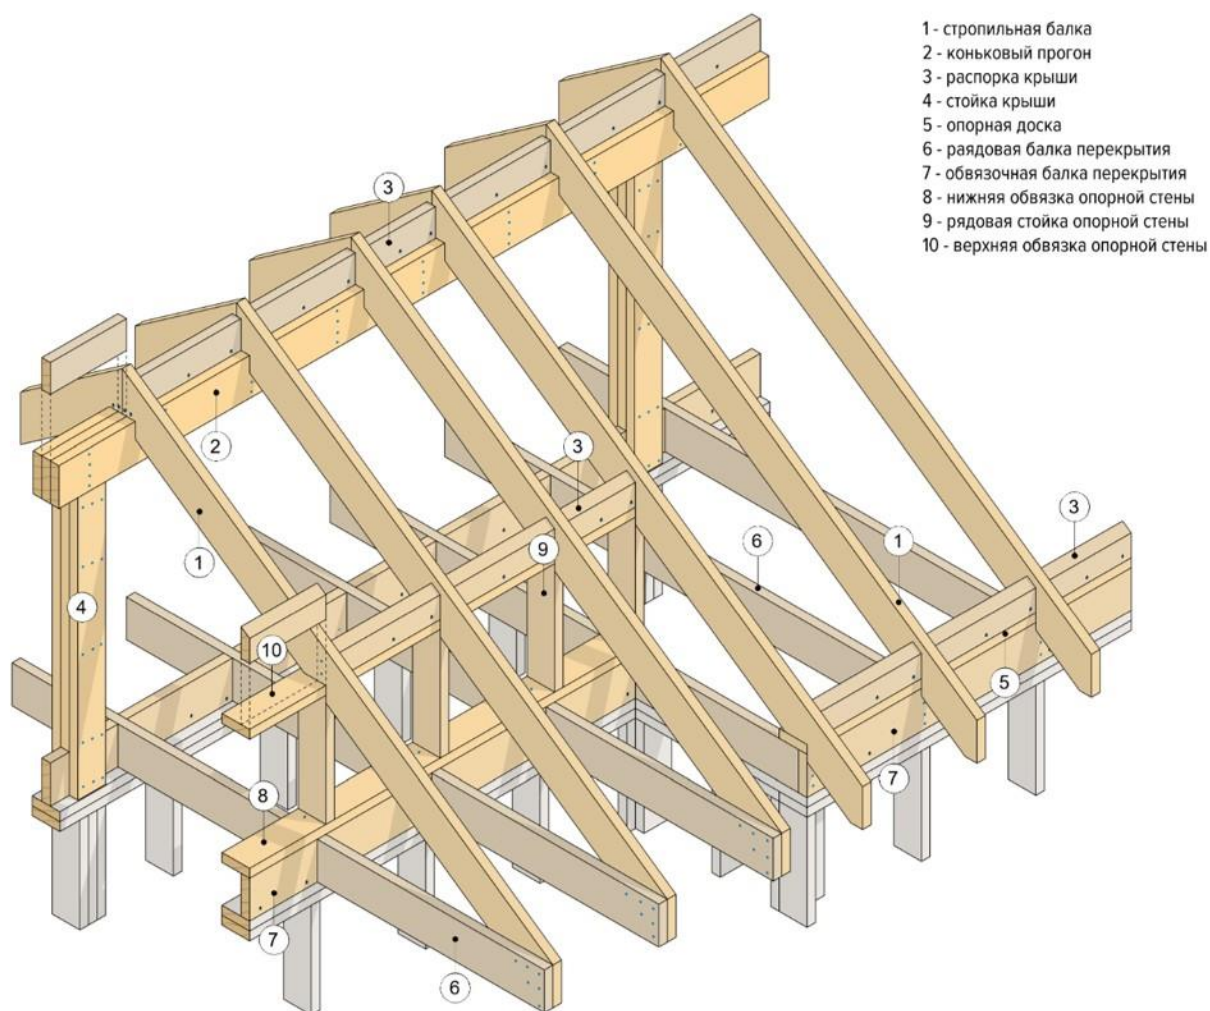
Каркас крыши наслонного типа с опорой стропил на опорную стену при смещении наружной несущей стены внутрь дома
